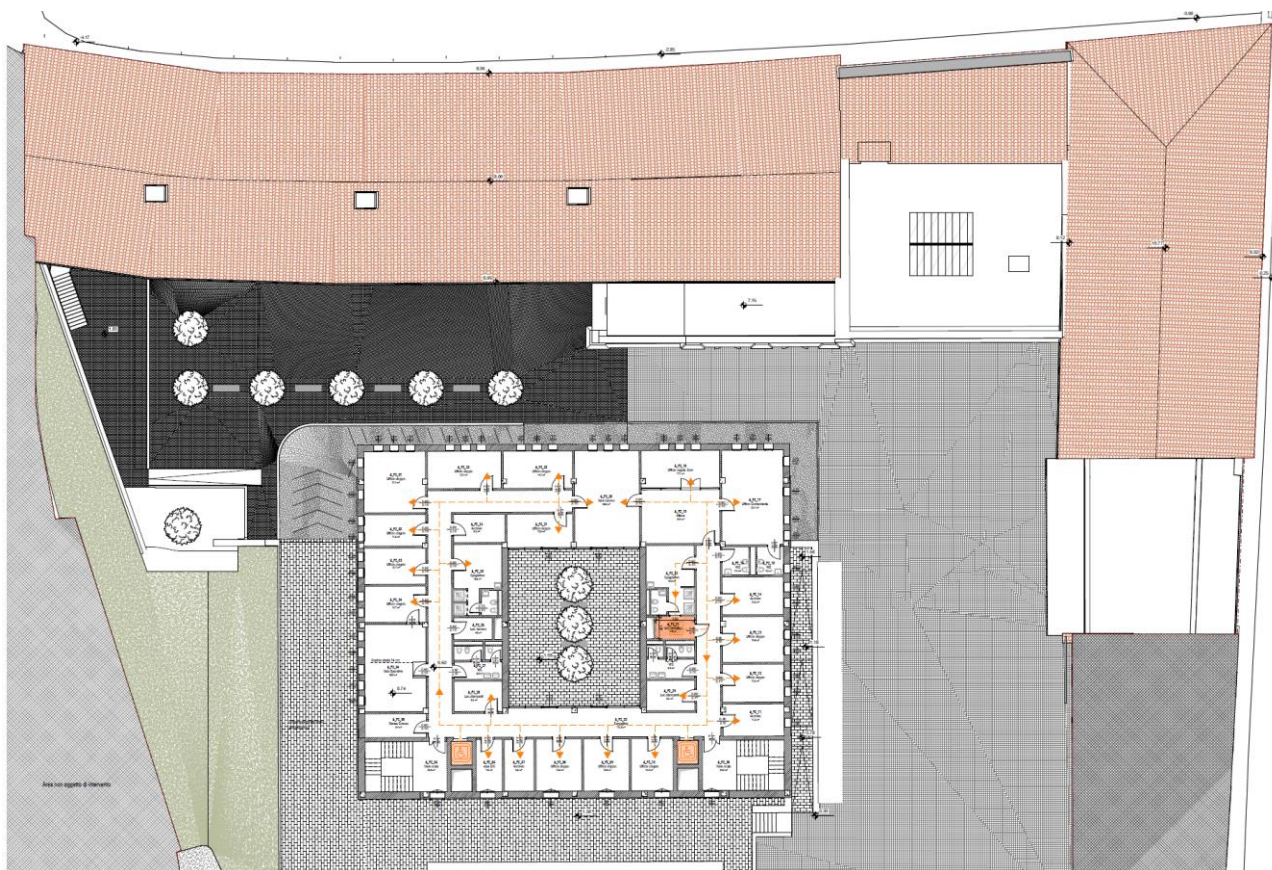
pianta piano secondo - estratto della tavola dedicata al superamento delle barriere architettoniche
